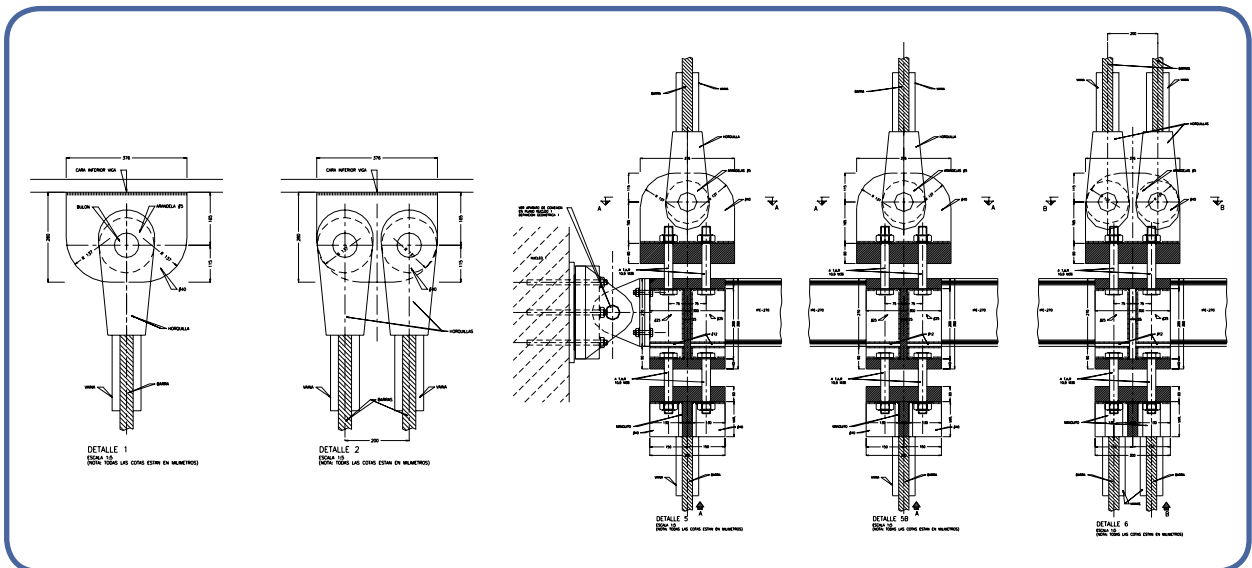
Detalle del encuentro de las cabezas de los tirantes a la cara inferior de las vigas longitudinales. Obsérvese que el primer tramo de tirante, el inmediatamente situado bajo la gran viga longitudinal, está biarticulado mediante pasadores, con el fin de no provocar flexiones indeseadas en las barras en ese primer tramo tan corto (1,25 m)
